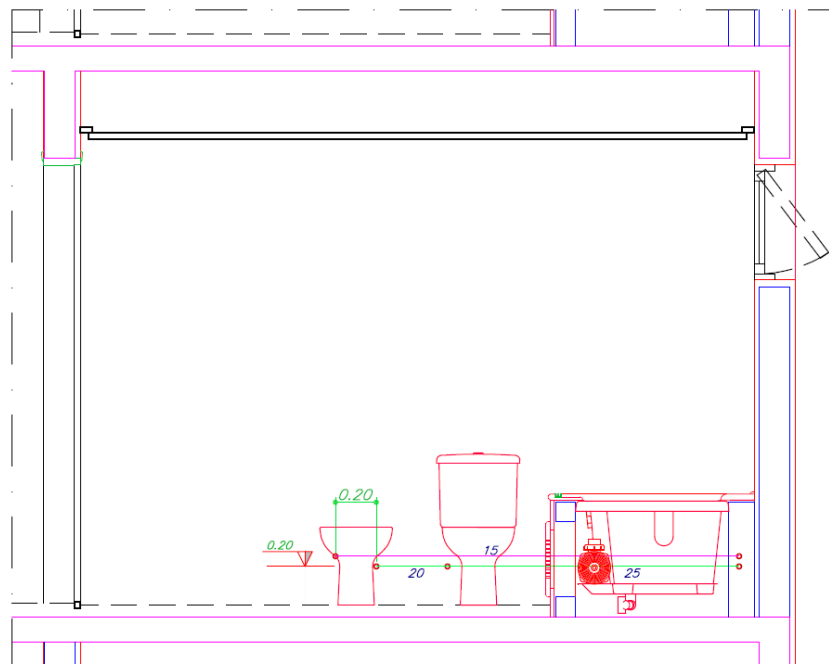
Em planta, a hidráulica é detalhada passando pelo pavimento inferior, saindo próximo da pia para o vaso sanitário.
